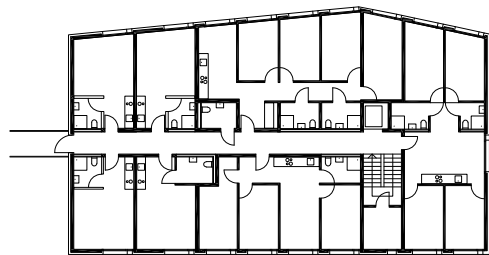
Grundriss Regelgeschoss, M.1:500 [© BF Vario]
